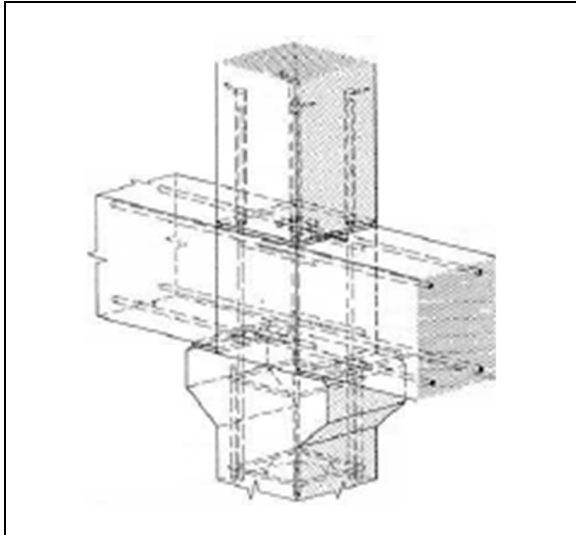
Interrupção de pilar com ligação por armaduras e betonagem integral do nó (Stupré, 1981)
